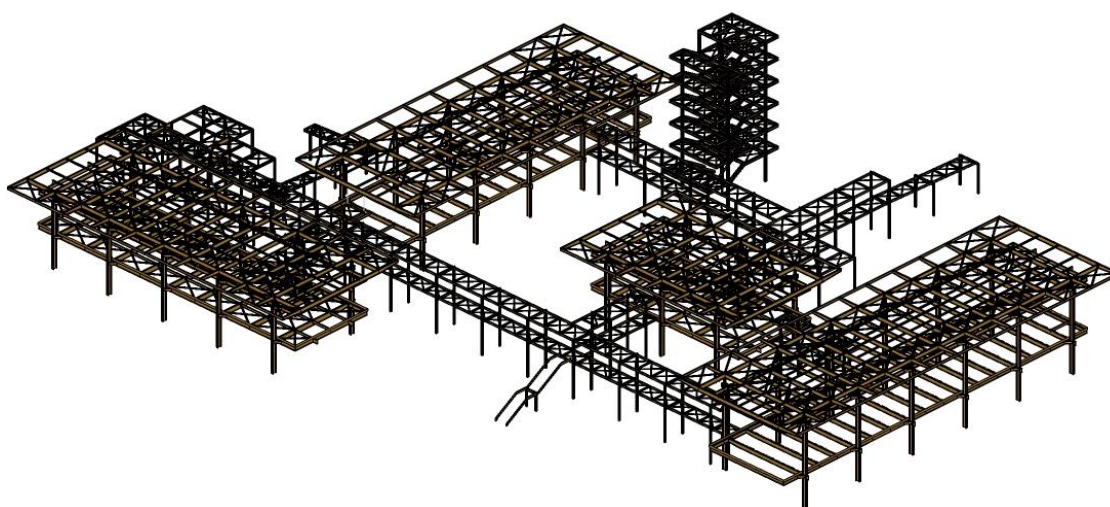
Estrutura metálica do Parque de Inovação e Sustentabilidade do Ambiente Construído.
